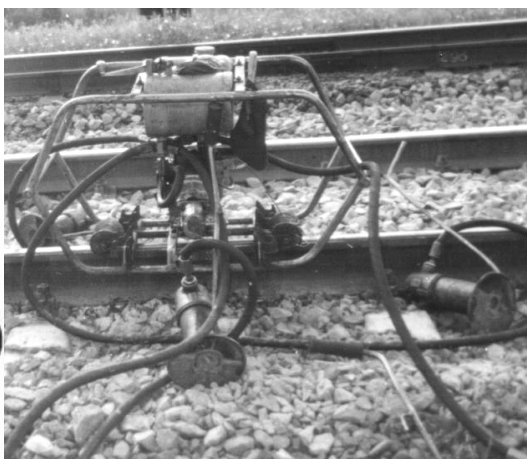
Моторный гидравлический рихтовочный прибор РГУ-1М
